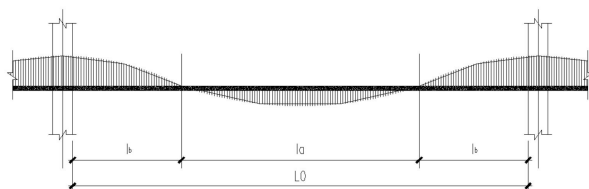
钢-混凝土组合梁正、负弯矩区段分区示意
